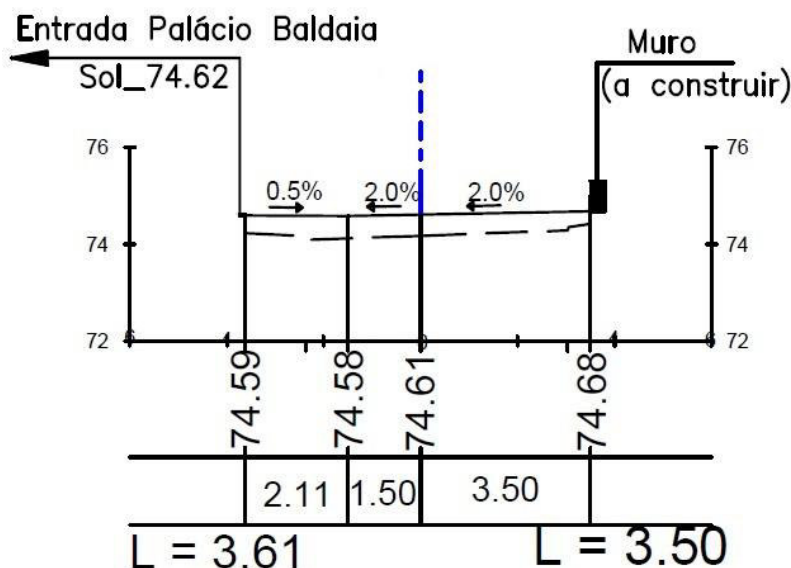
Corte Transversal da Estrada das Garridas [76]
